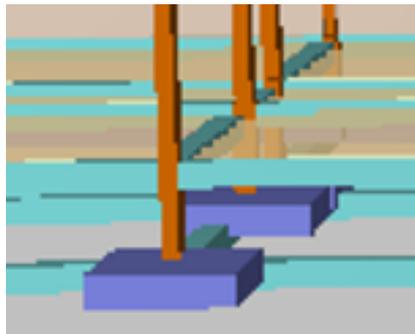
Imagen 3D del encuentro entre zapatas y vigas riostras (CYPECAD)
